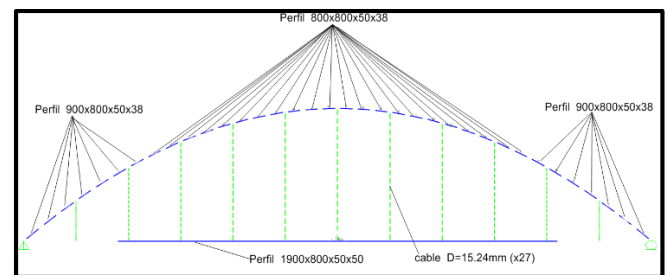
Secciones del arco; Dovelas extremas y Dovelas Centrales. Fuente: Autores.
